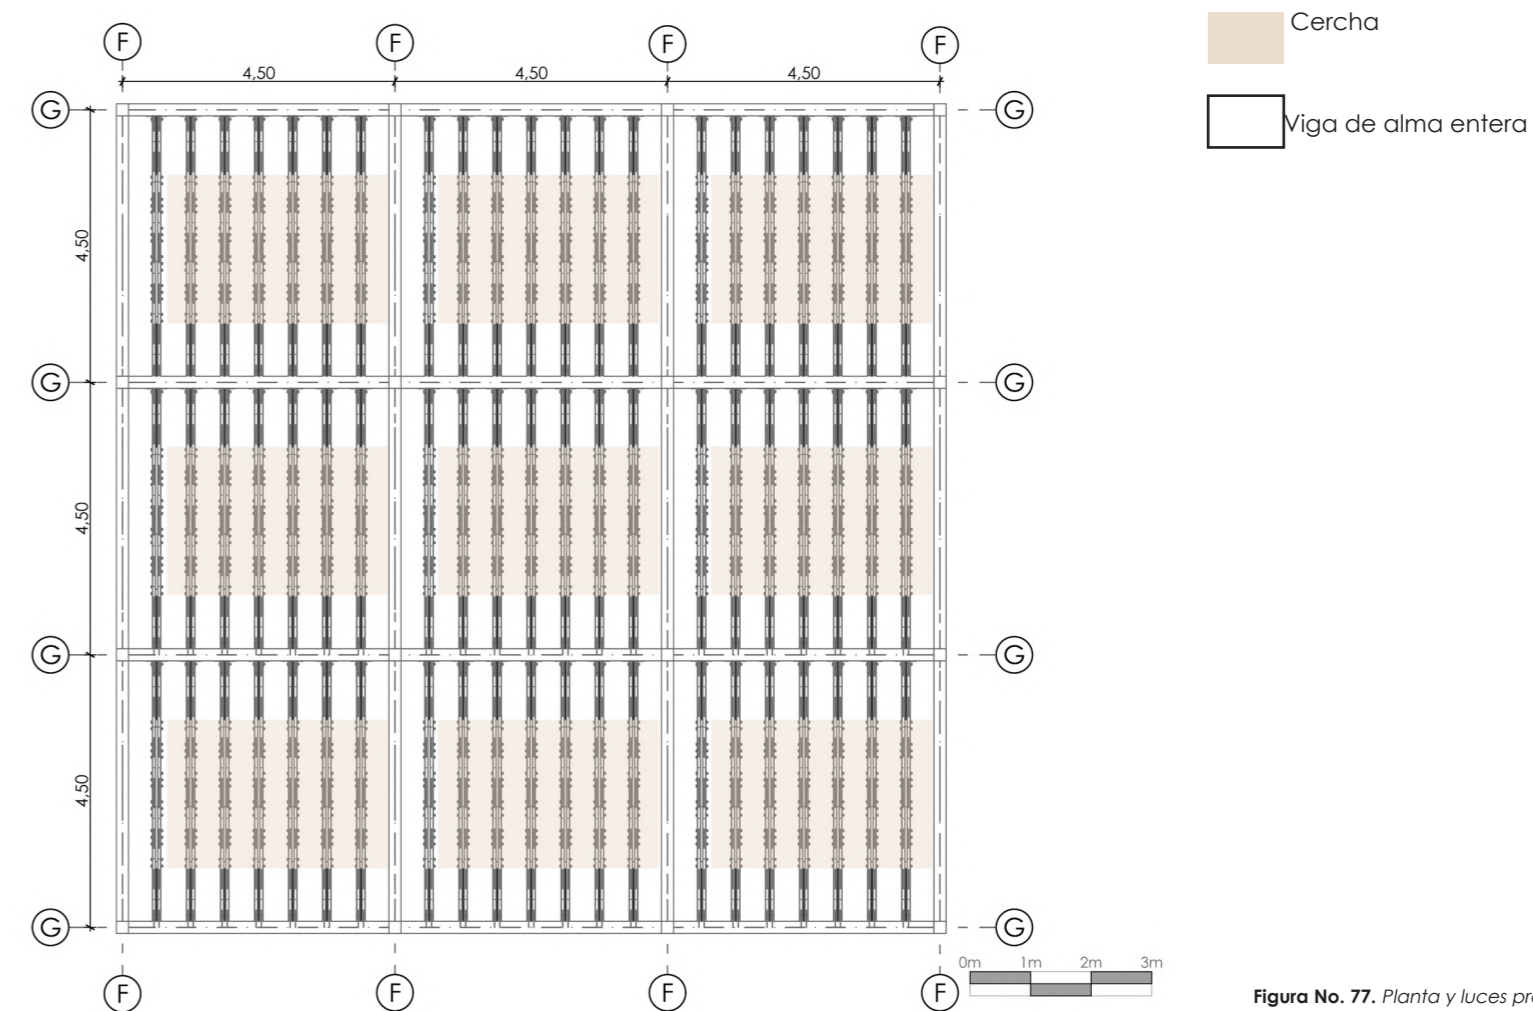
Planta y luces propuestas del Entrepiso Mixto I
